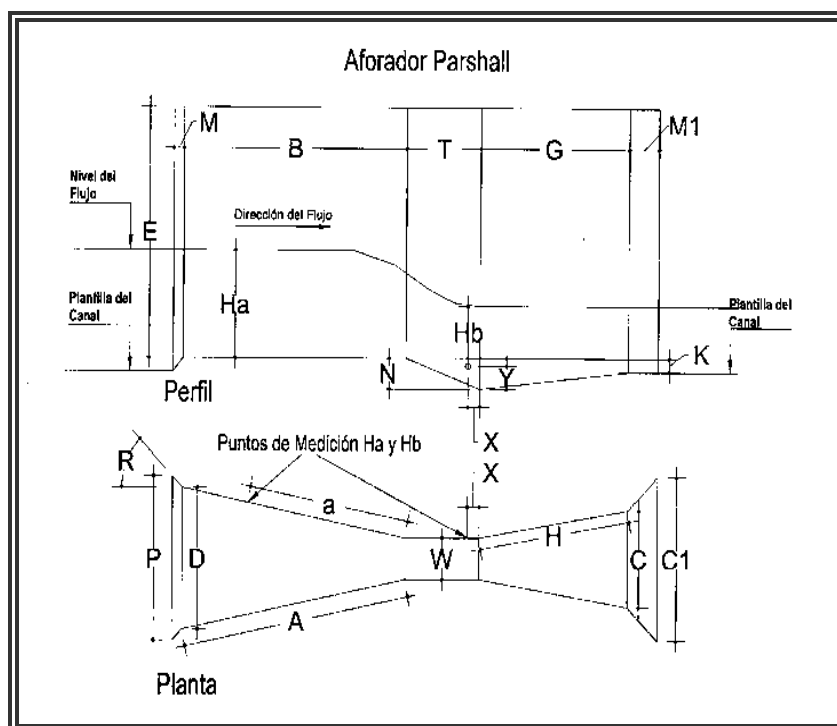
Vista en perfil y en planta del aforador Parshall y su nomenclatura
